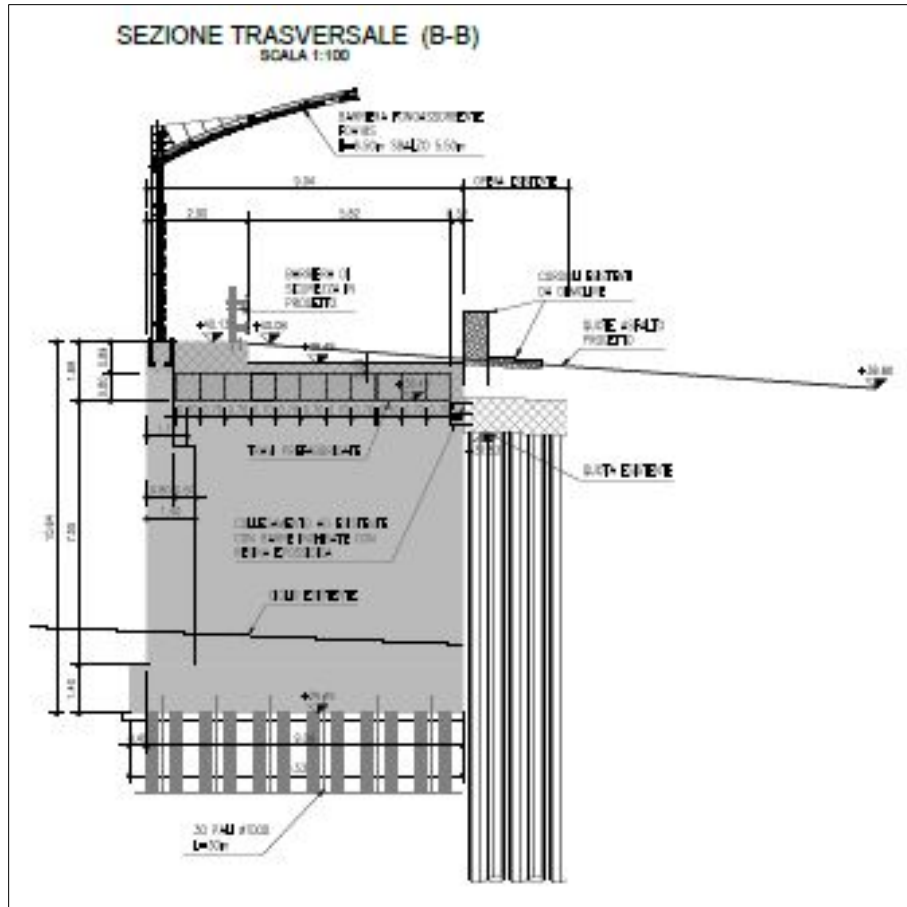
Sezione trasversale (in corrispondenza impalcato)
